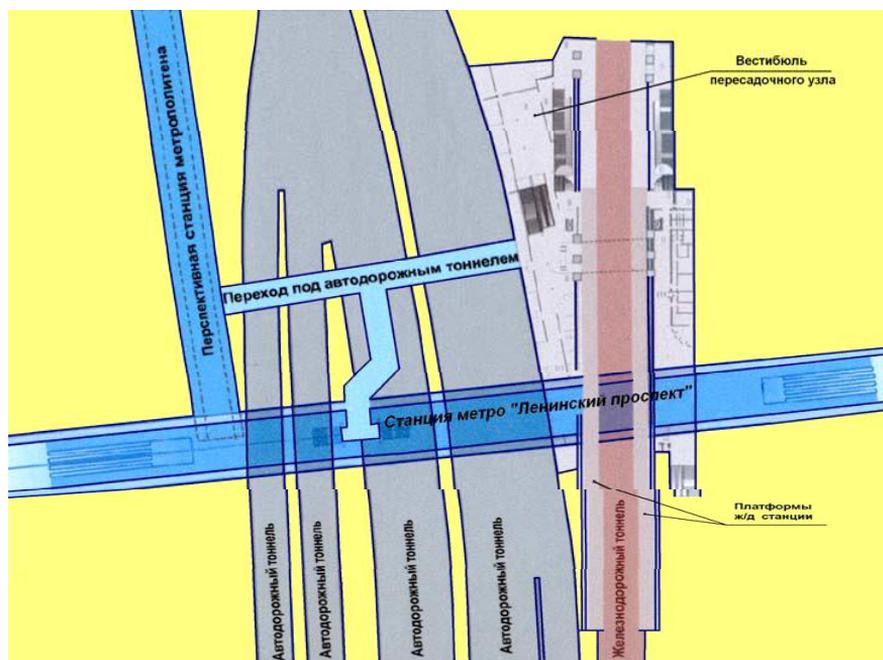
План тоннелей и пересадочного узла в месте сечения со станцией метро Гагаринского тоннеля
